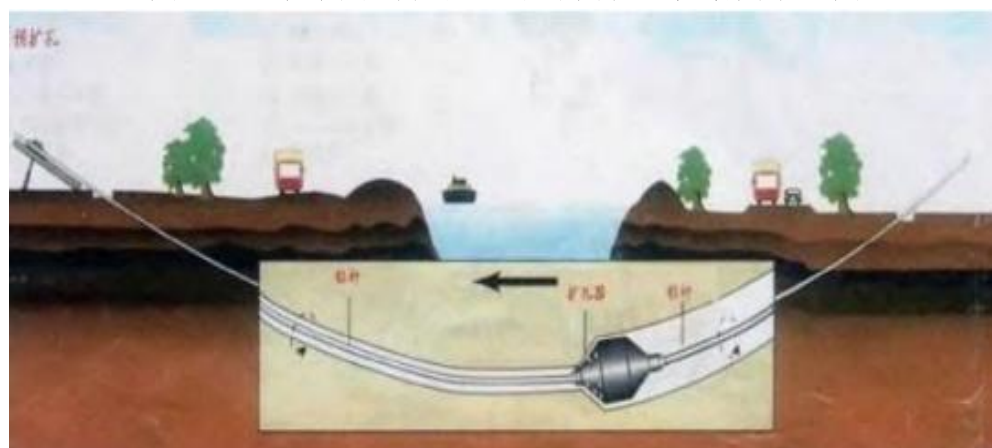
定向钻穿越施工预扩孔过程断面示意图
